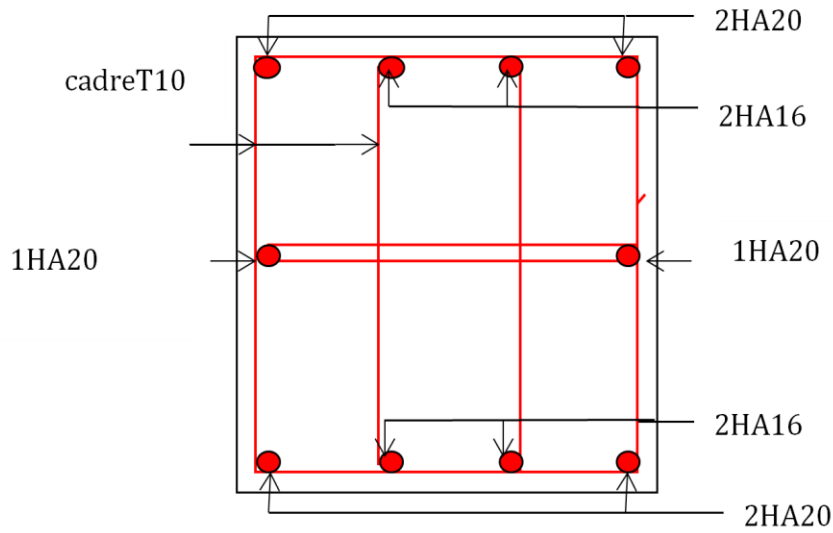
Ferrailage poteaux 4^{ème} à 7^{ème} étages.
